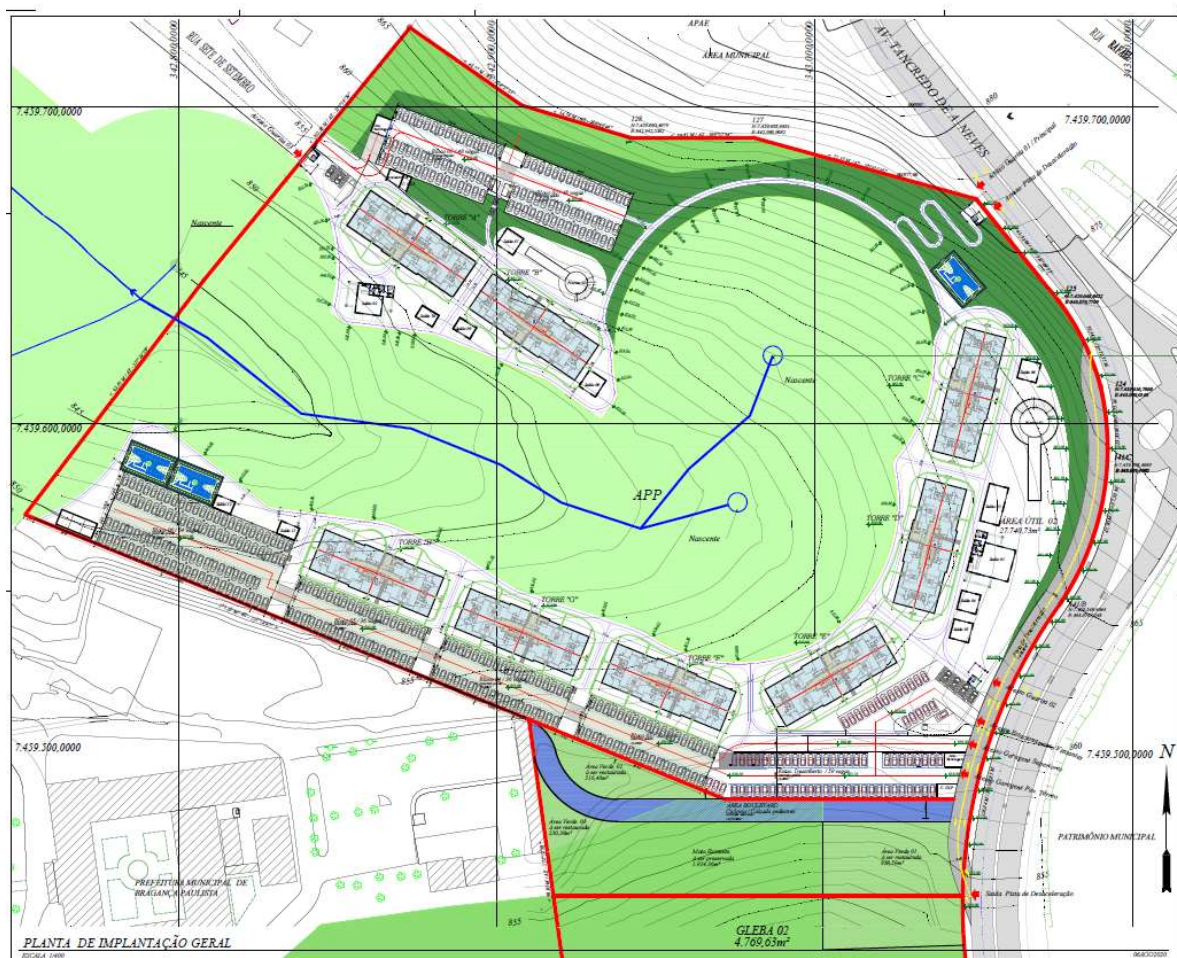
Imagem do Projeto Arquitetônico - Planta de Implantação Geral do Empreendimento, vide detalhes conforme Anexo 07.
